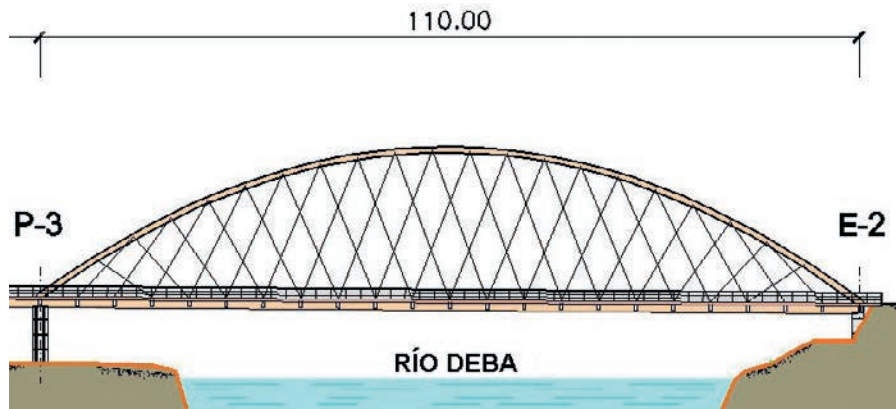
Alzado del puente arco. Esquema de malla tipo Network con anclajes cada 5 m
